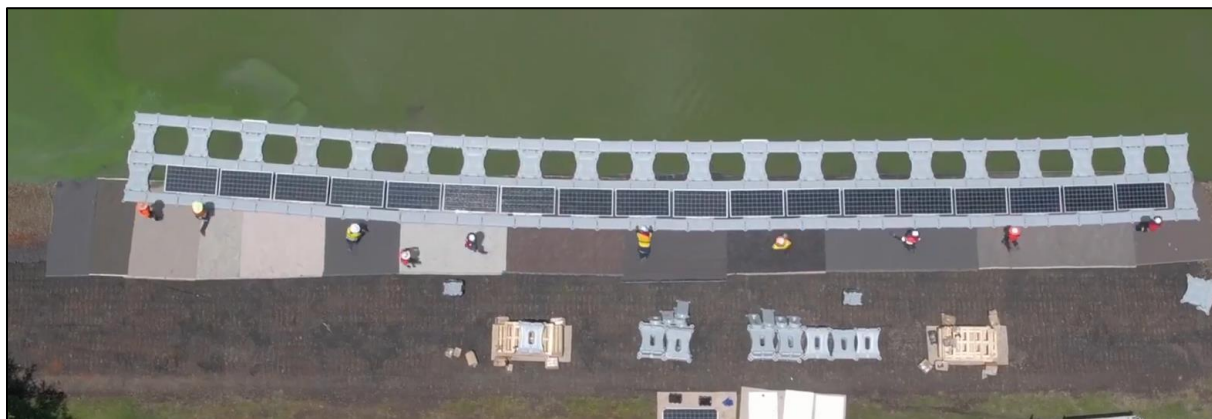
Zones d'ancrage en fond de bassin et en berges
